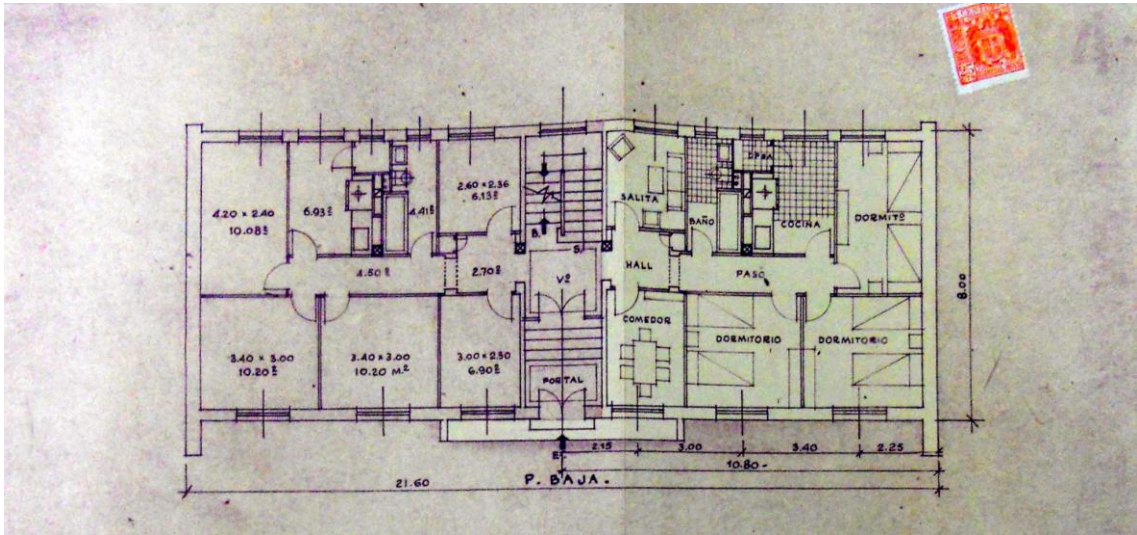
Planta baja, viviendas para Minas Figaredo S.A., 1954 (Peñule); fotografía procedente del Archivo Municipal de Mieres
